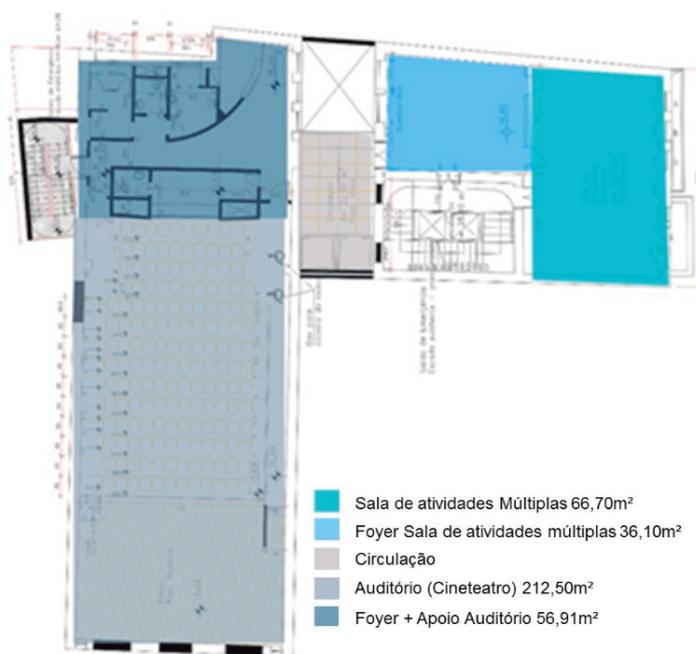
Planta baixa do terceiro pavimento do Centro Cultural Erico Verissimo. Porto Alegre, 2016.
